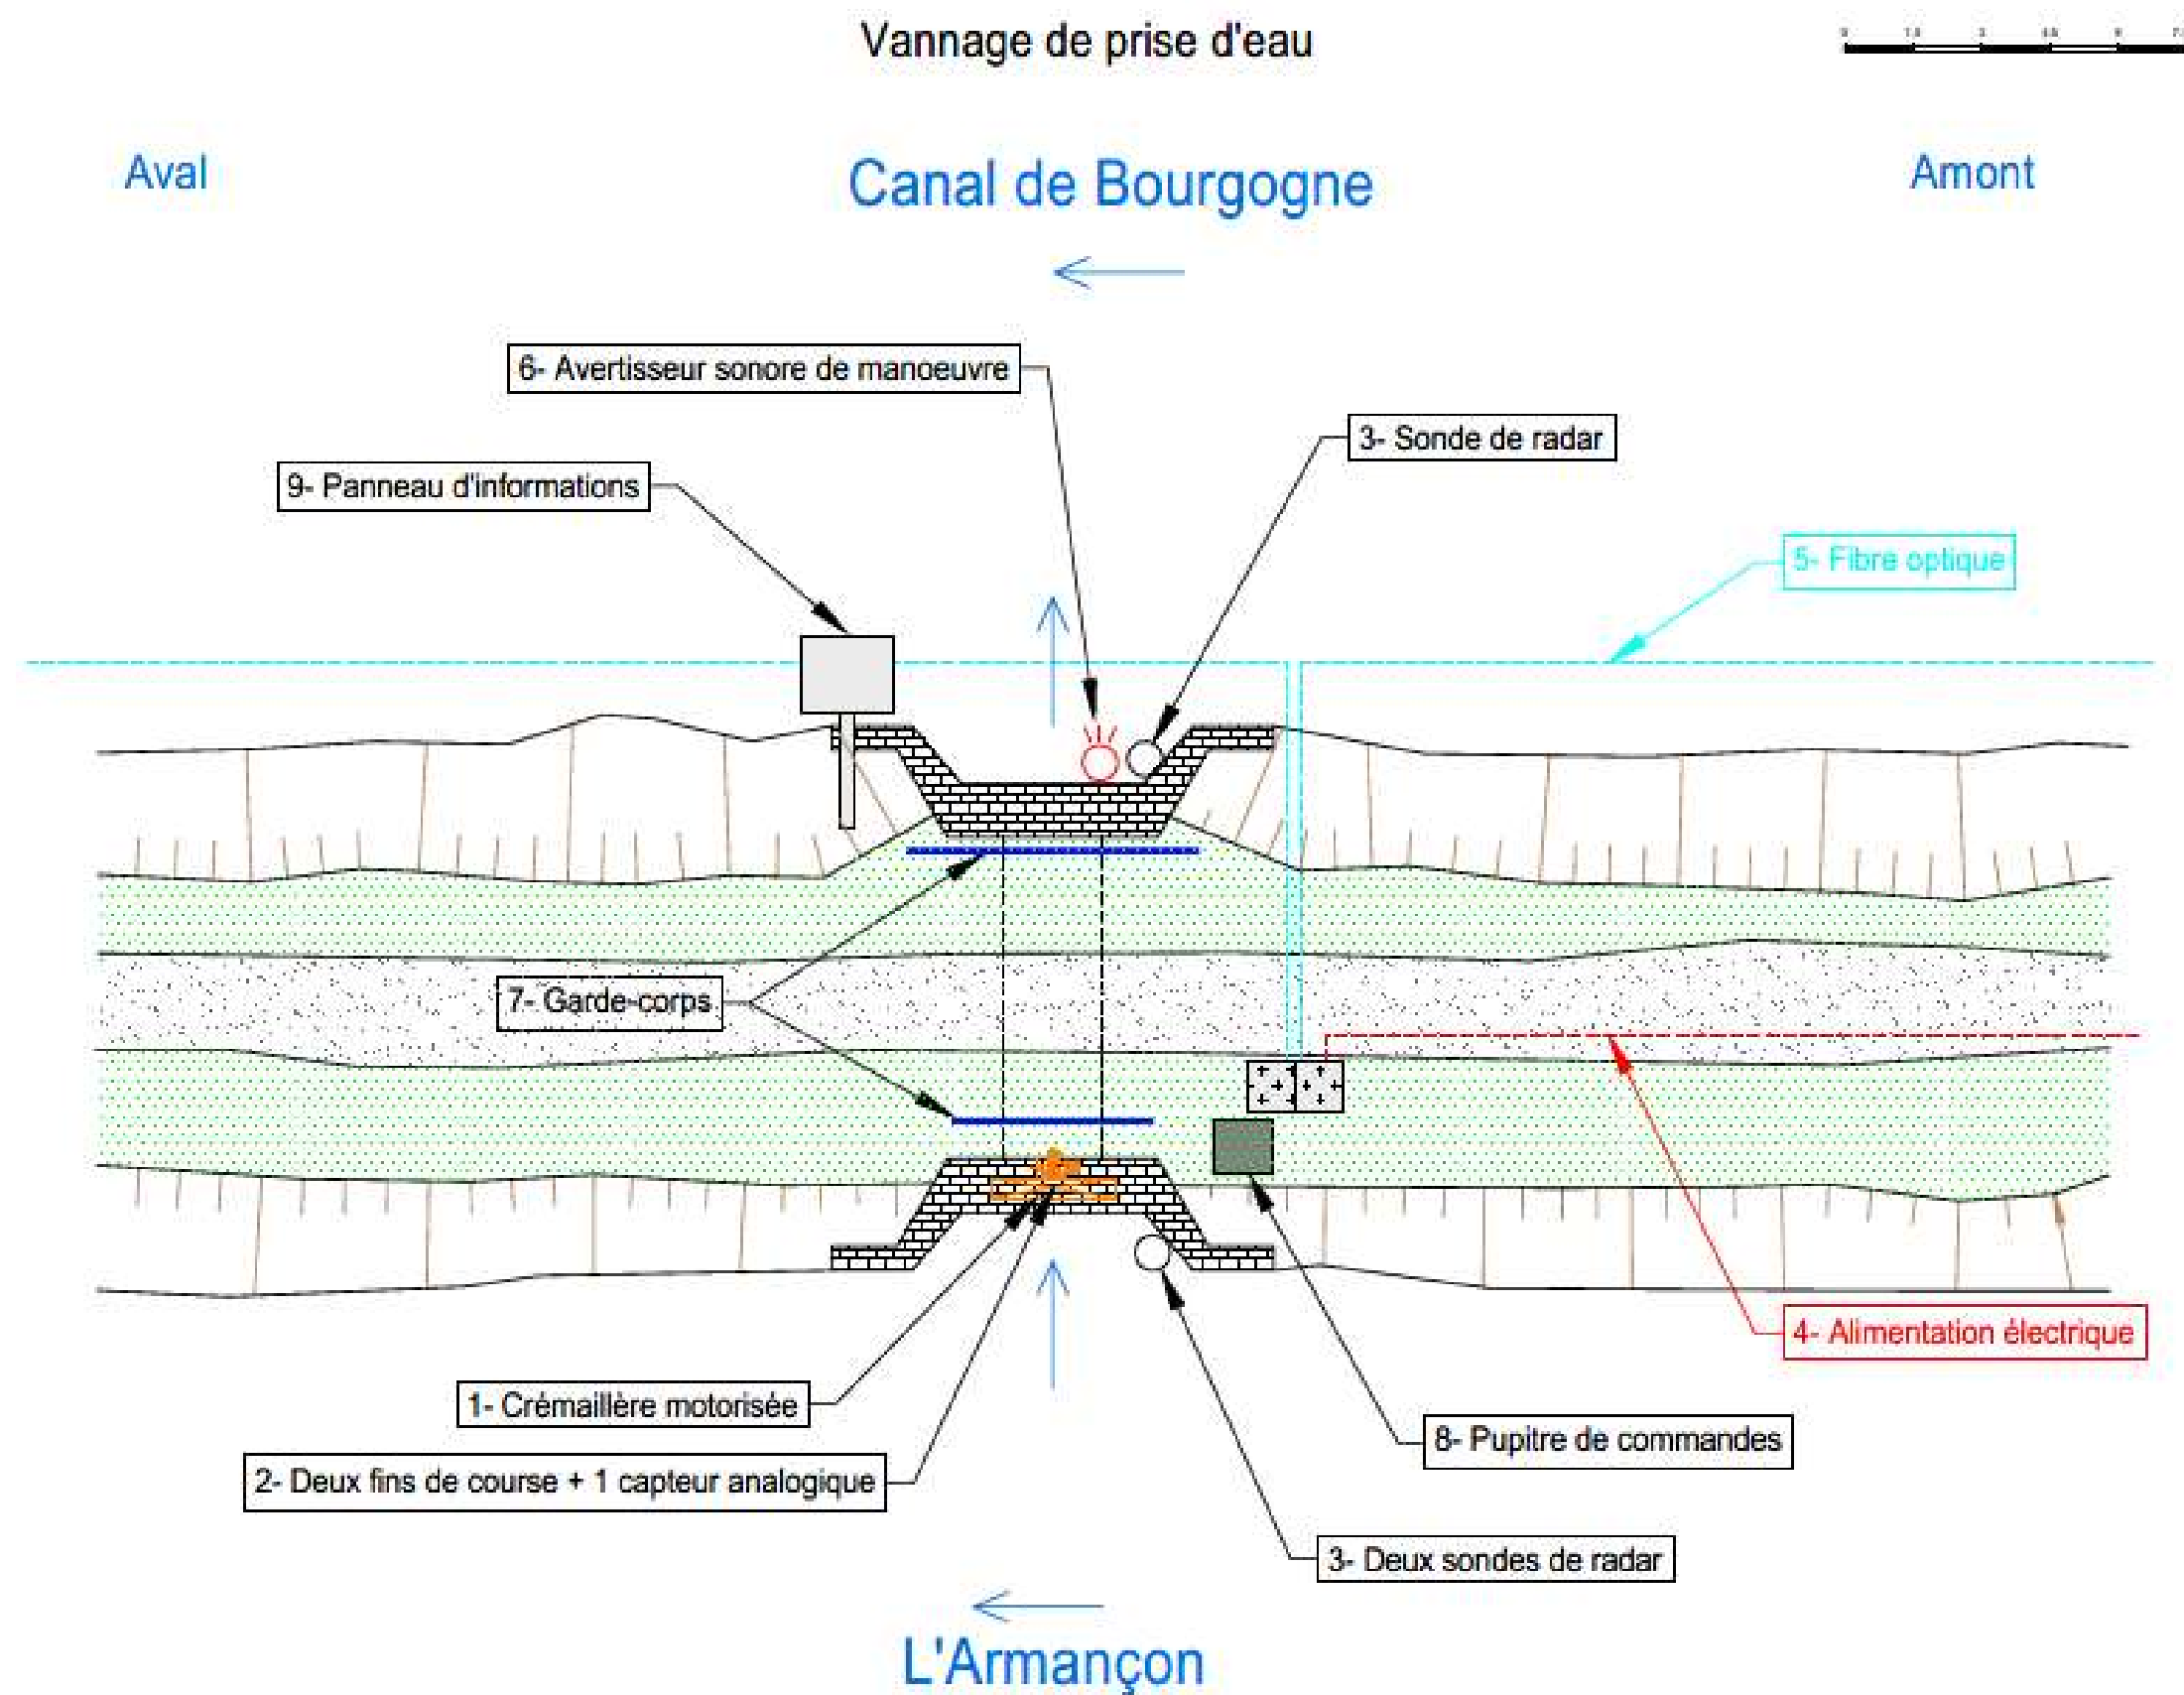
Vue en plan de l'ouvrage hydraulique standard modernisé (prise d'eau)
